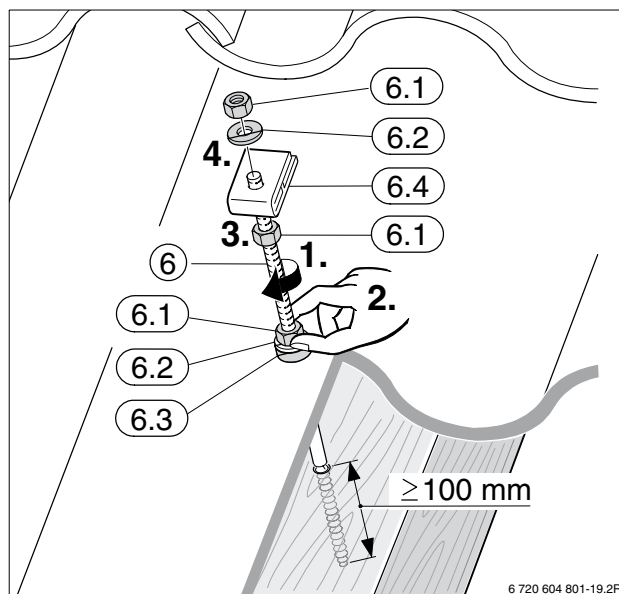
Stockschraube montieren (Mindesteinschraubtiefe 100 mm)
